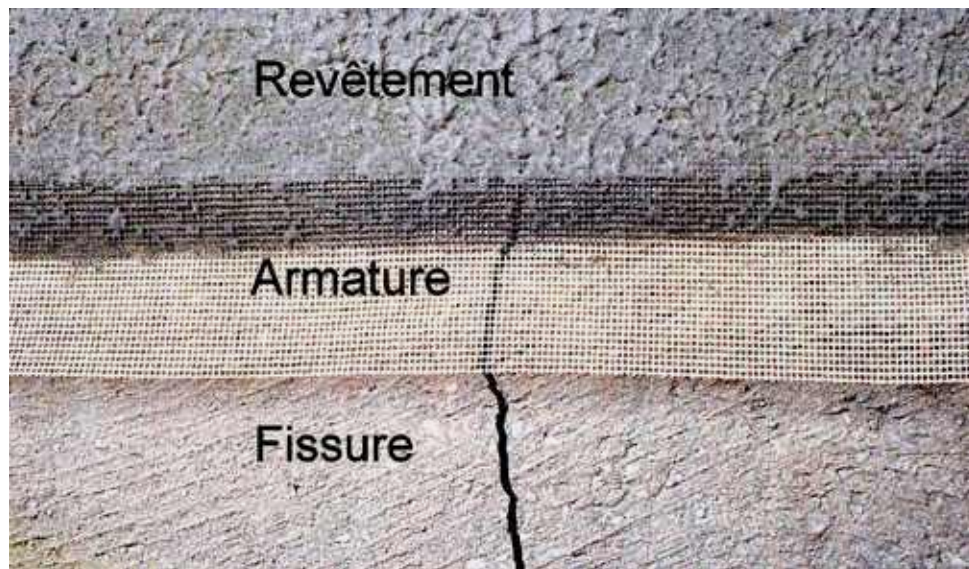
revêtement armé assurant une protection localisée d'une fissure (crédit photo SIKA)
